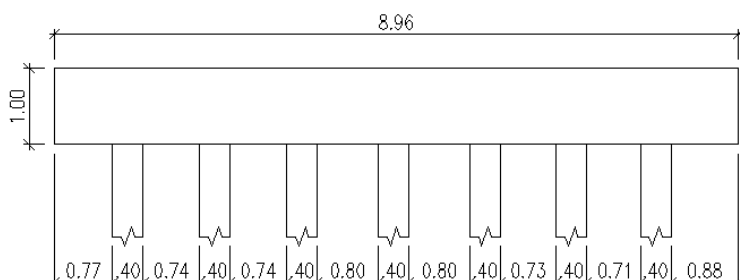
Alzado viga cabezal eje P2. Fuente: Propia
